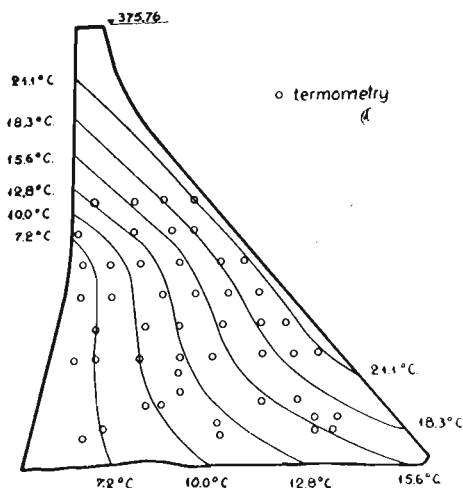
Układ chłodzenia betonu zapory Boulder.
